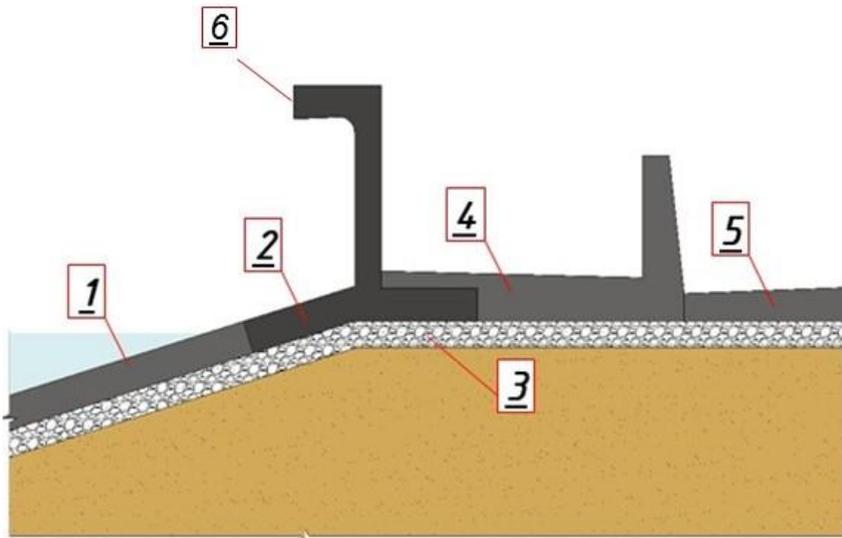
Конструкція залізобетонного кріплення відкосів гребель з ґрунтових матеріалів:
